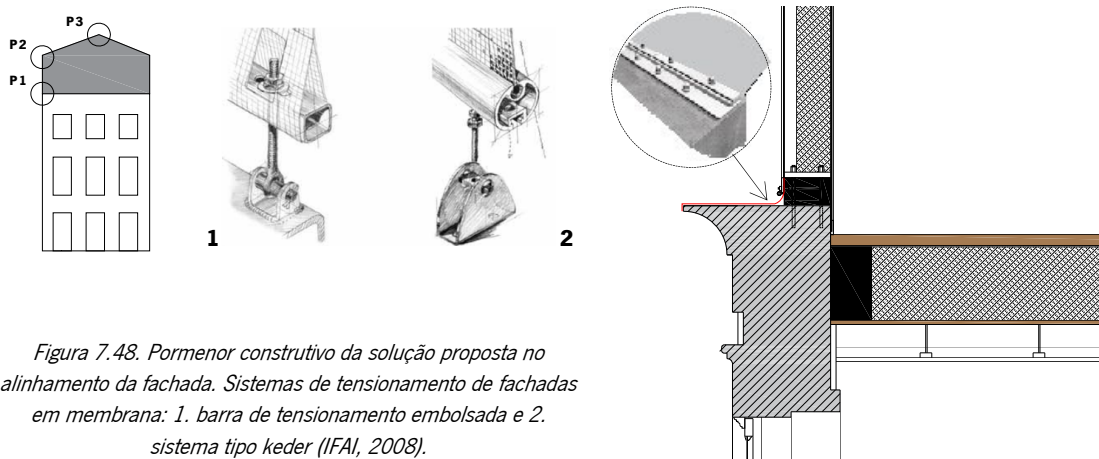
Pormenor construtivo da solução proposta no alinhamento da fachada. Sistemas de tensãoção de fachadas em membrana: 1. barra de tensãoção embolsada e 2. sistema tipo keder (IFAI, 2008).
